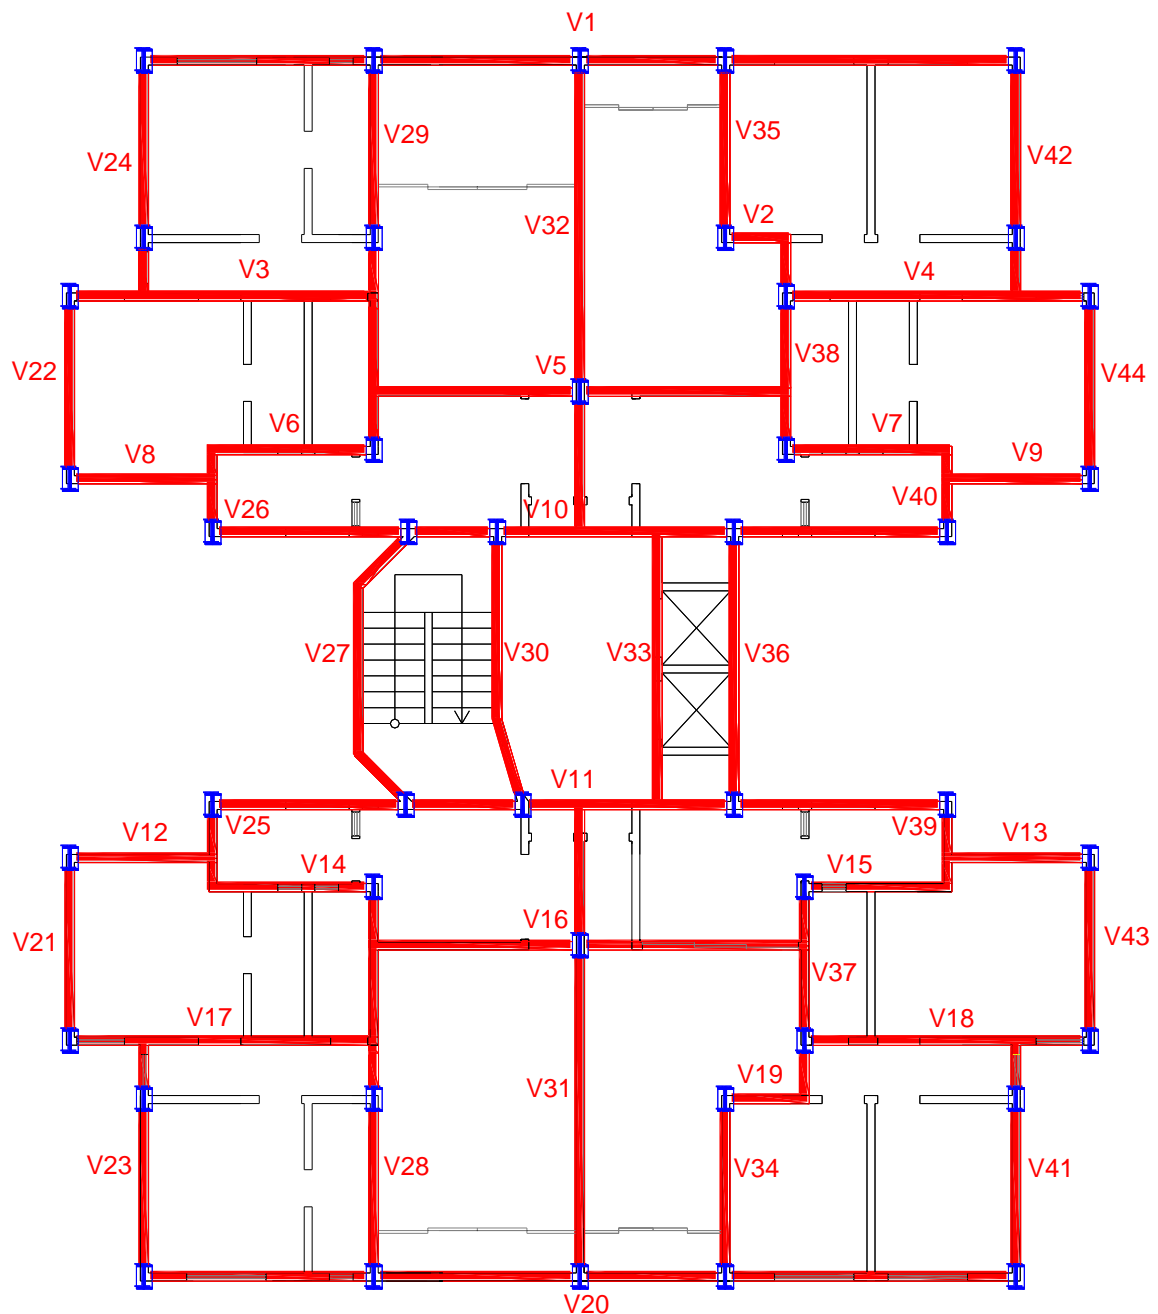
Localização dos pilares e das vigas em aço – Residencial Bôscoli.
